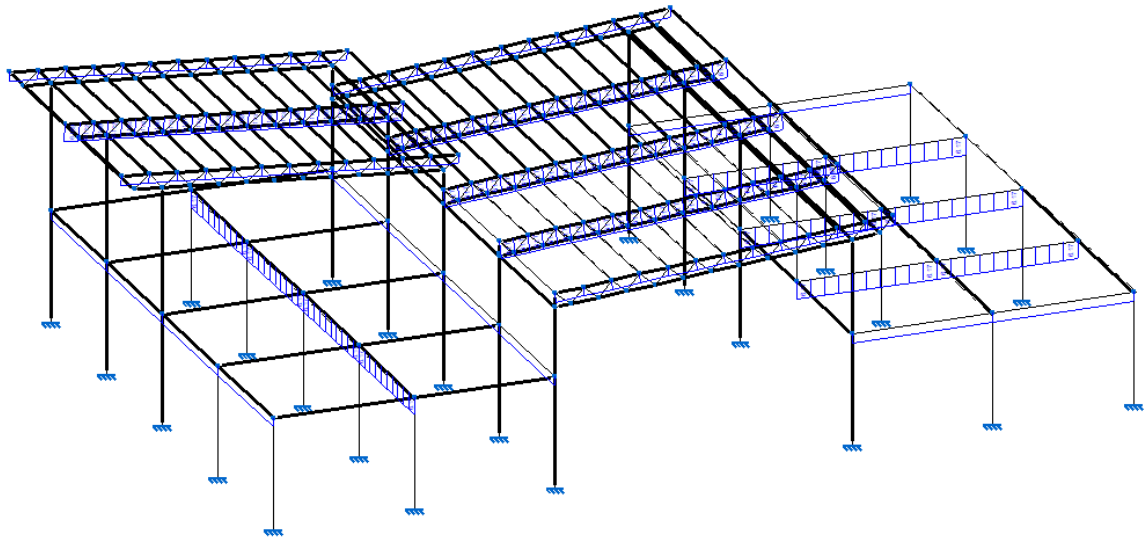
Sobrecargas de viento en estructura metálica. Fuente: Elaboración propia
